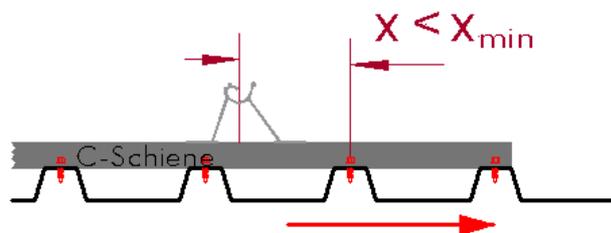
Detail zur Befestigung des KSV am Trapezblechdach - Standardbefestigung
